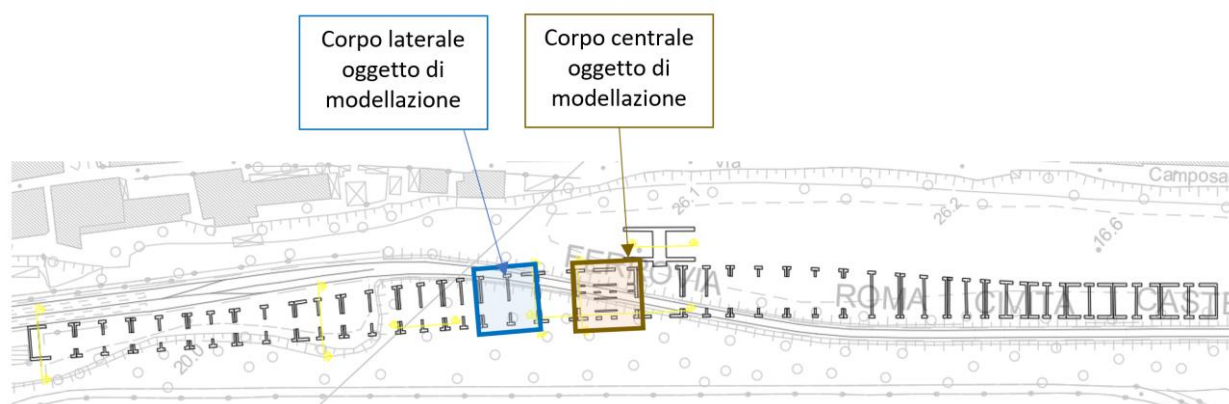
Planimetria con individuazione del concio centrale e laterale oggetto di modellazione.
